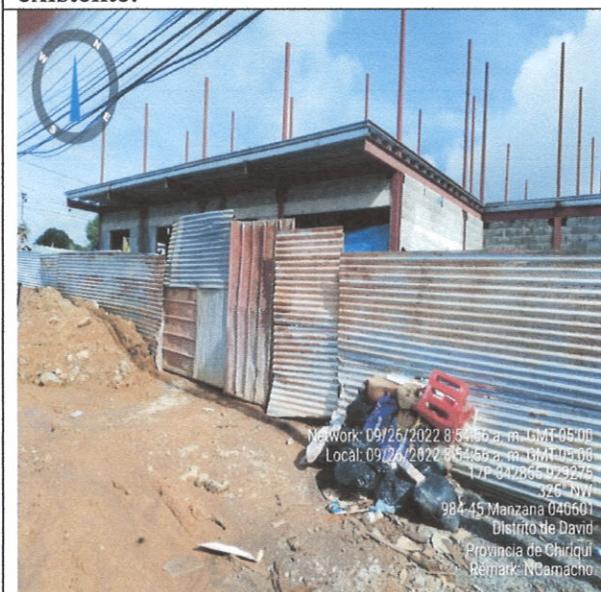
Vista del costado derecho colindante con la calle a Valle de La Luna.
